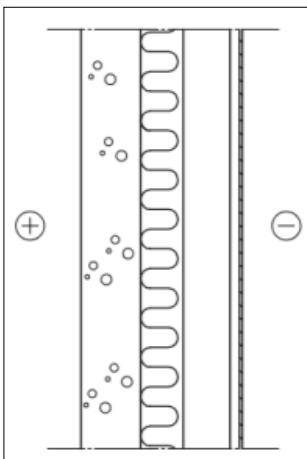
Rakenneavauksista 10 ja 11 todettiin ulkoseinärakenteessa sisäkuoren betonikerros, jonka paksuus ei ole tiedosta. Eristeenä on 100 mm:n betonikuitulevy ja ulkokuorena 110 mm:n paksuinen betonikerros.
